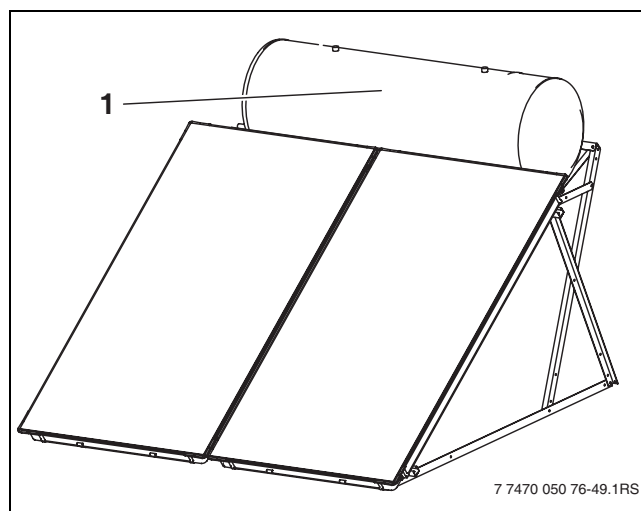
Aperçu du montage sur toit terrasse (ici système 300 l)
